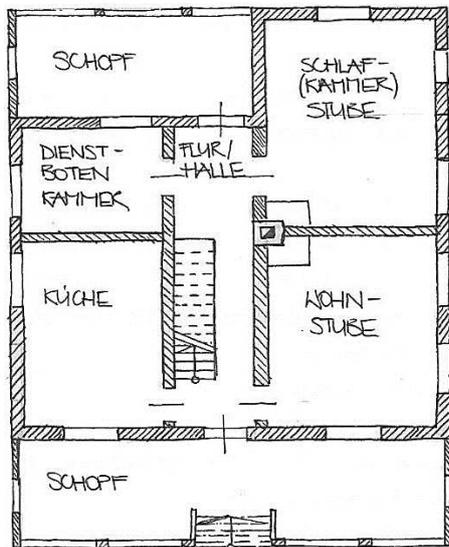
Vorarlberger Bauernhaus, Grundriss Erdgeschoß
